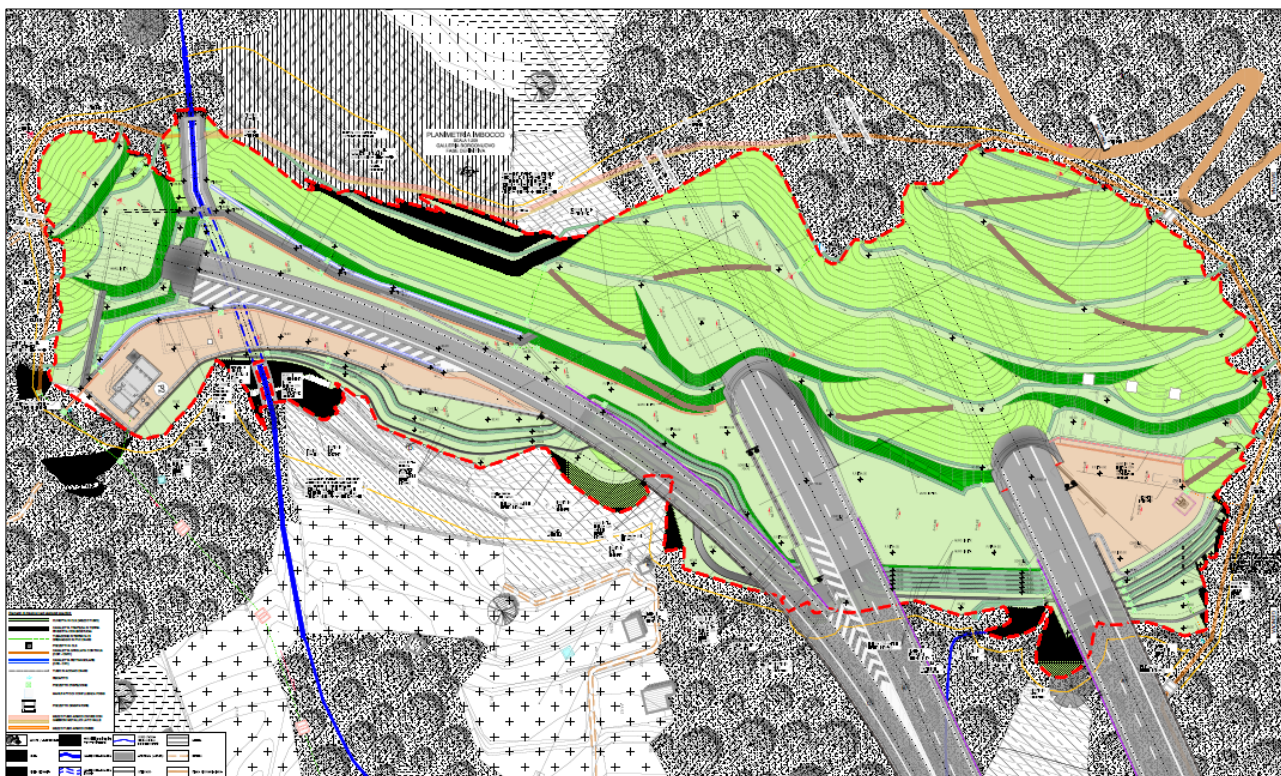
Planimetria finale dell'area d'imbocco (fonte: elaborato 110728-LL8C-PE-A1-G01-GF01E-SSF00-D-AUA0621-1)
